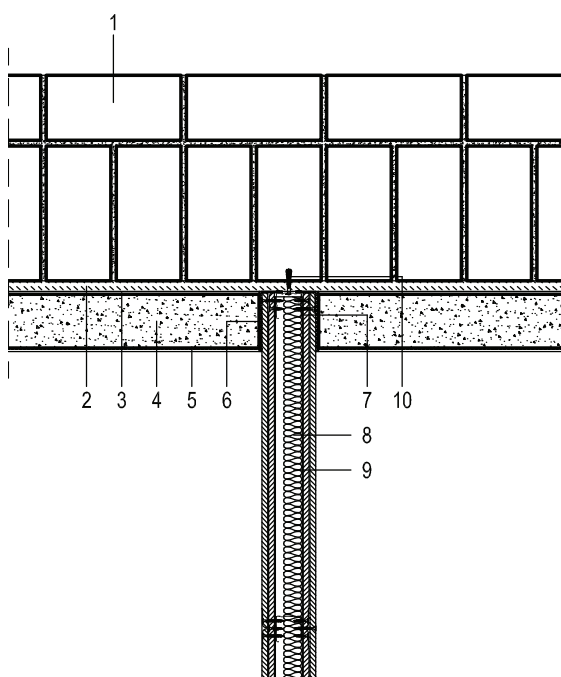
Styk ściany zewnętrznej i wewnętrznej murowanej – wariant I
